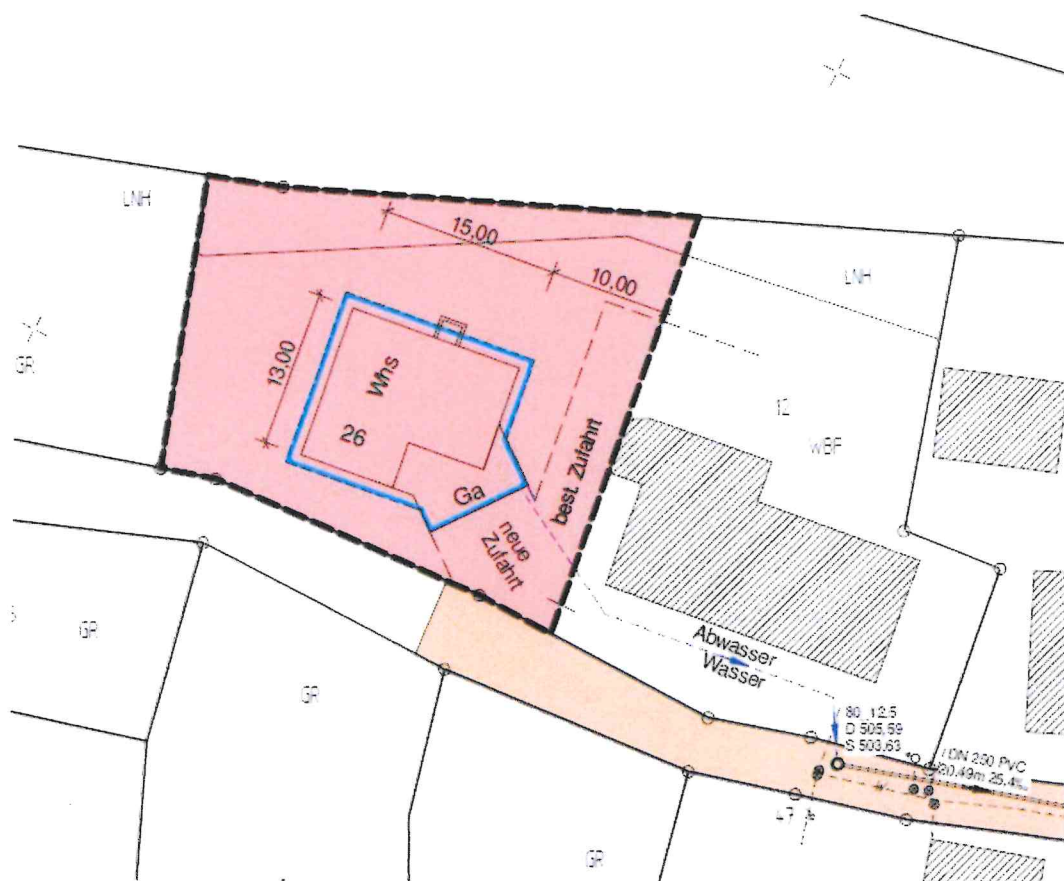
BPlan „Pfaffenholzstraße 26“, Stühlingen, Grimmelshofen
